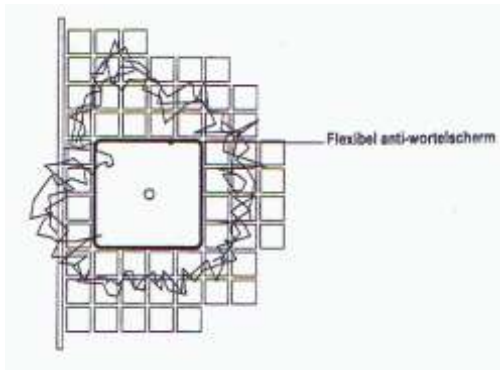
detail 2b – gecontroleerde barriërvorming voor diepe wortelgroei
